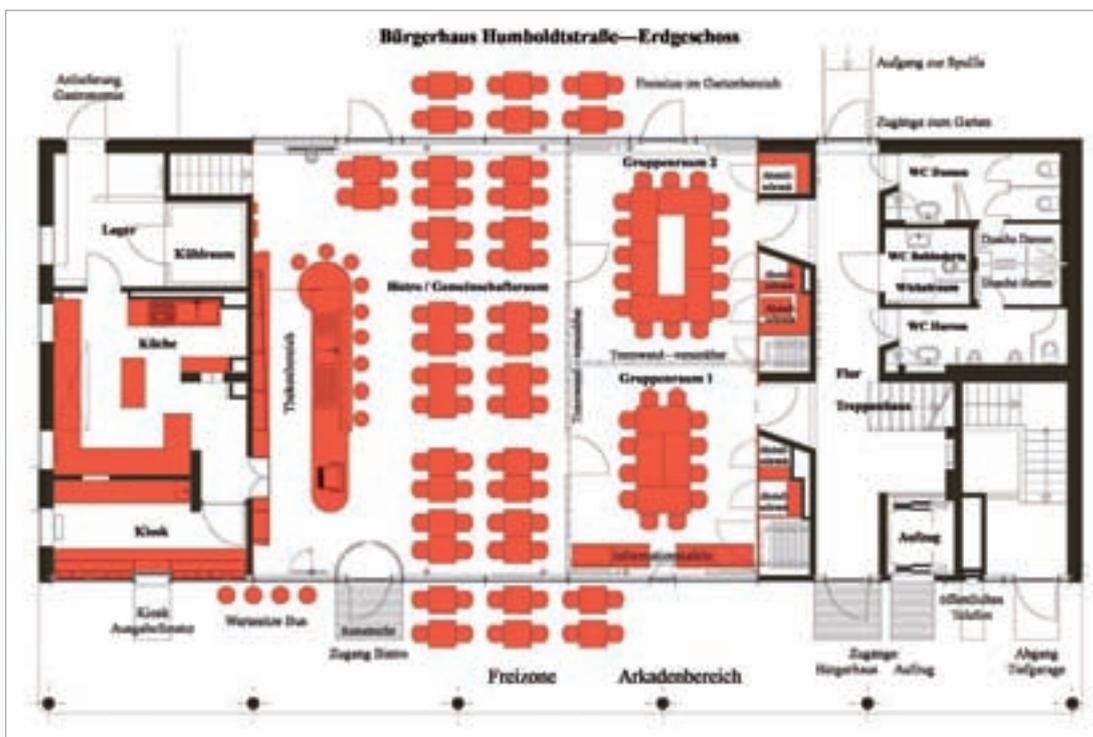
Bürgerhaus – EG Grundriss (Entwurf: M. Blasch)
